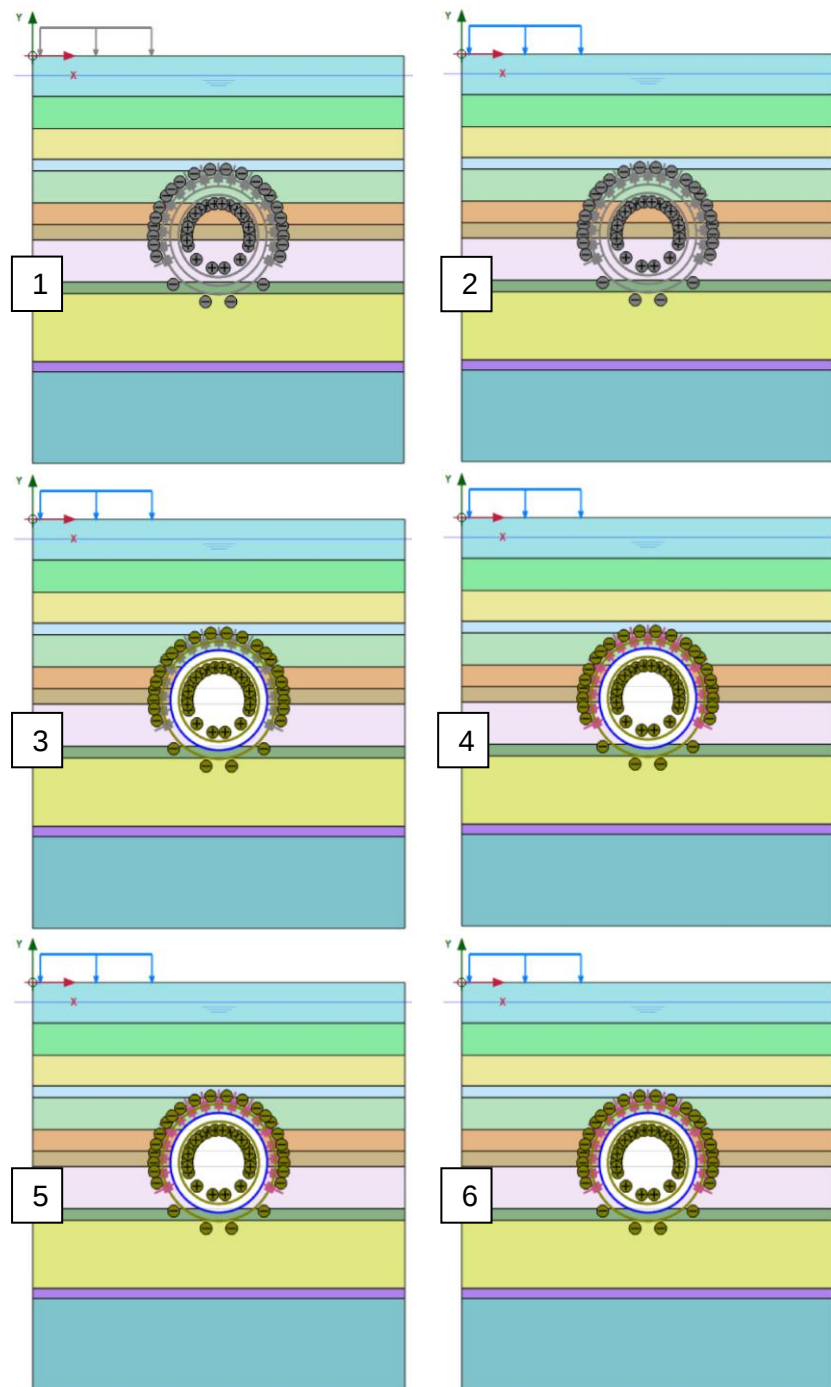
Pemodelan tunnel TBM di DK2+823.23 (potongan 4)
